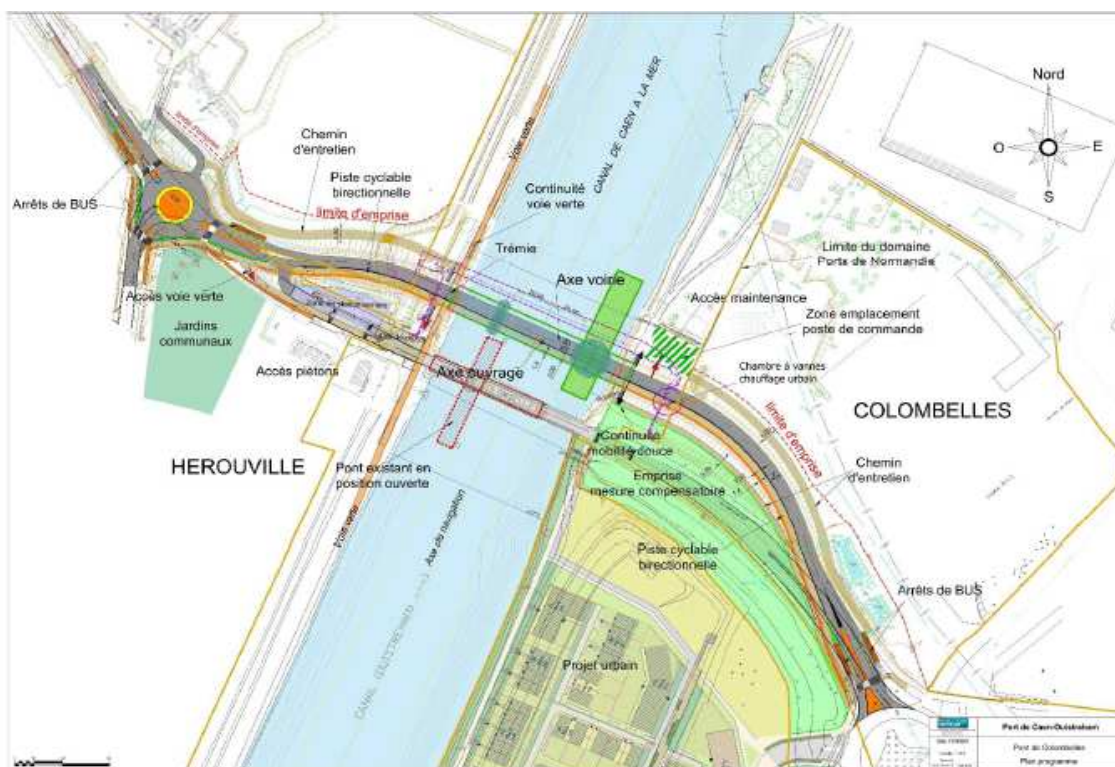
plan général du projet de remplacement du pont de Colombelles (source : dossier)
